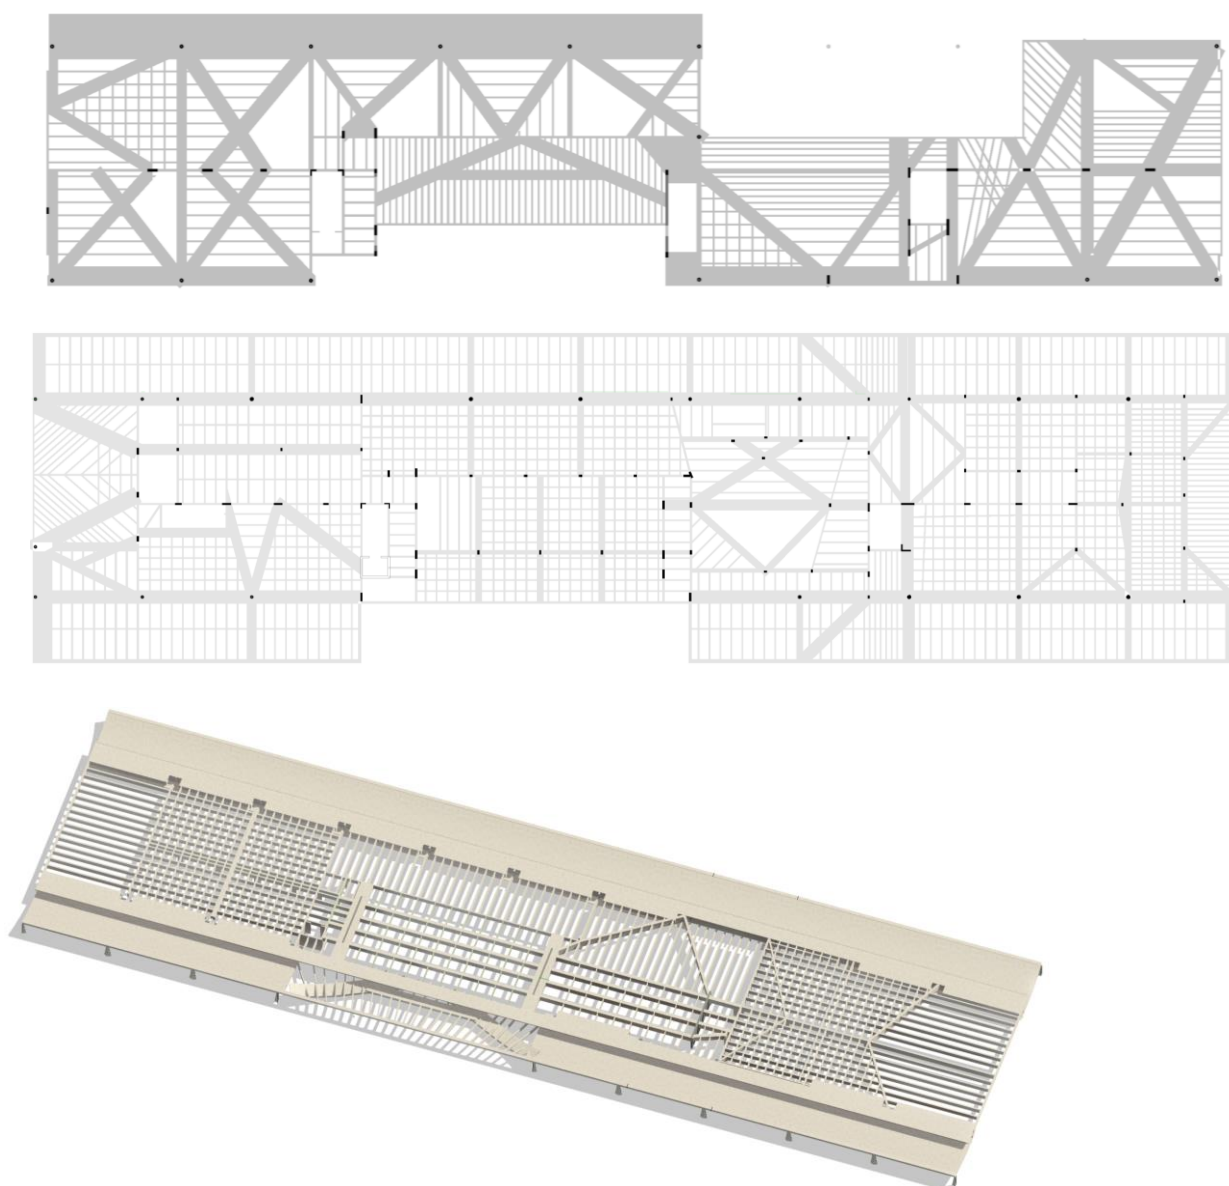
Planta de forma da primeira, segunda e terceira laje, respectivamente. Fonte: Autoral.
